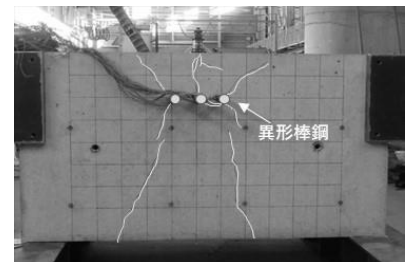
コンクリート表面のひび割れ (Case-3側面)
